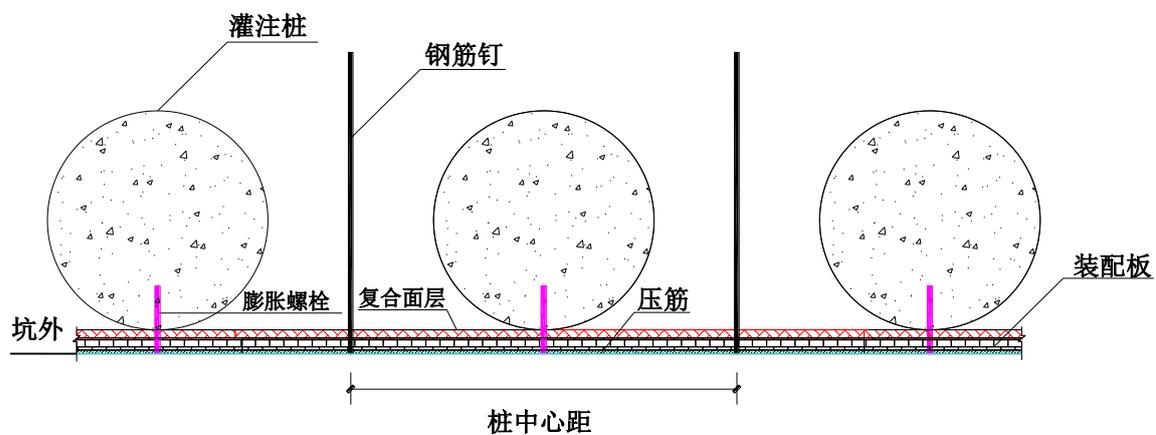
膨胀螺栓连接装配式面板剖面图
